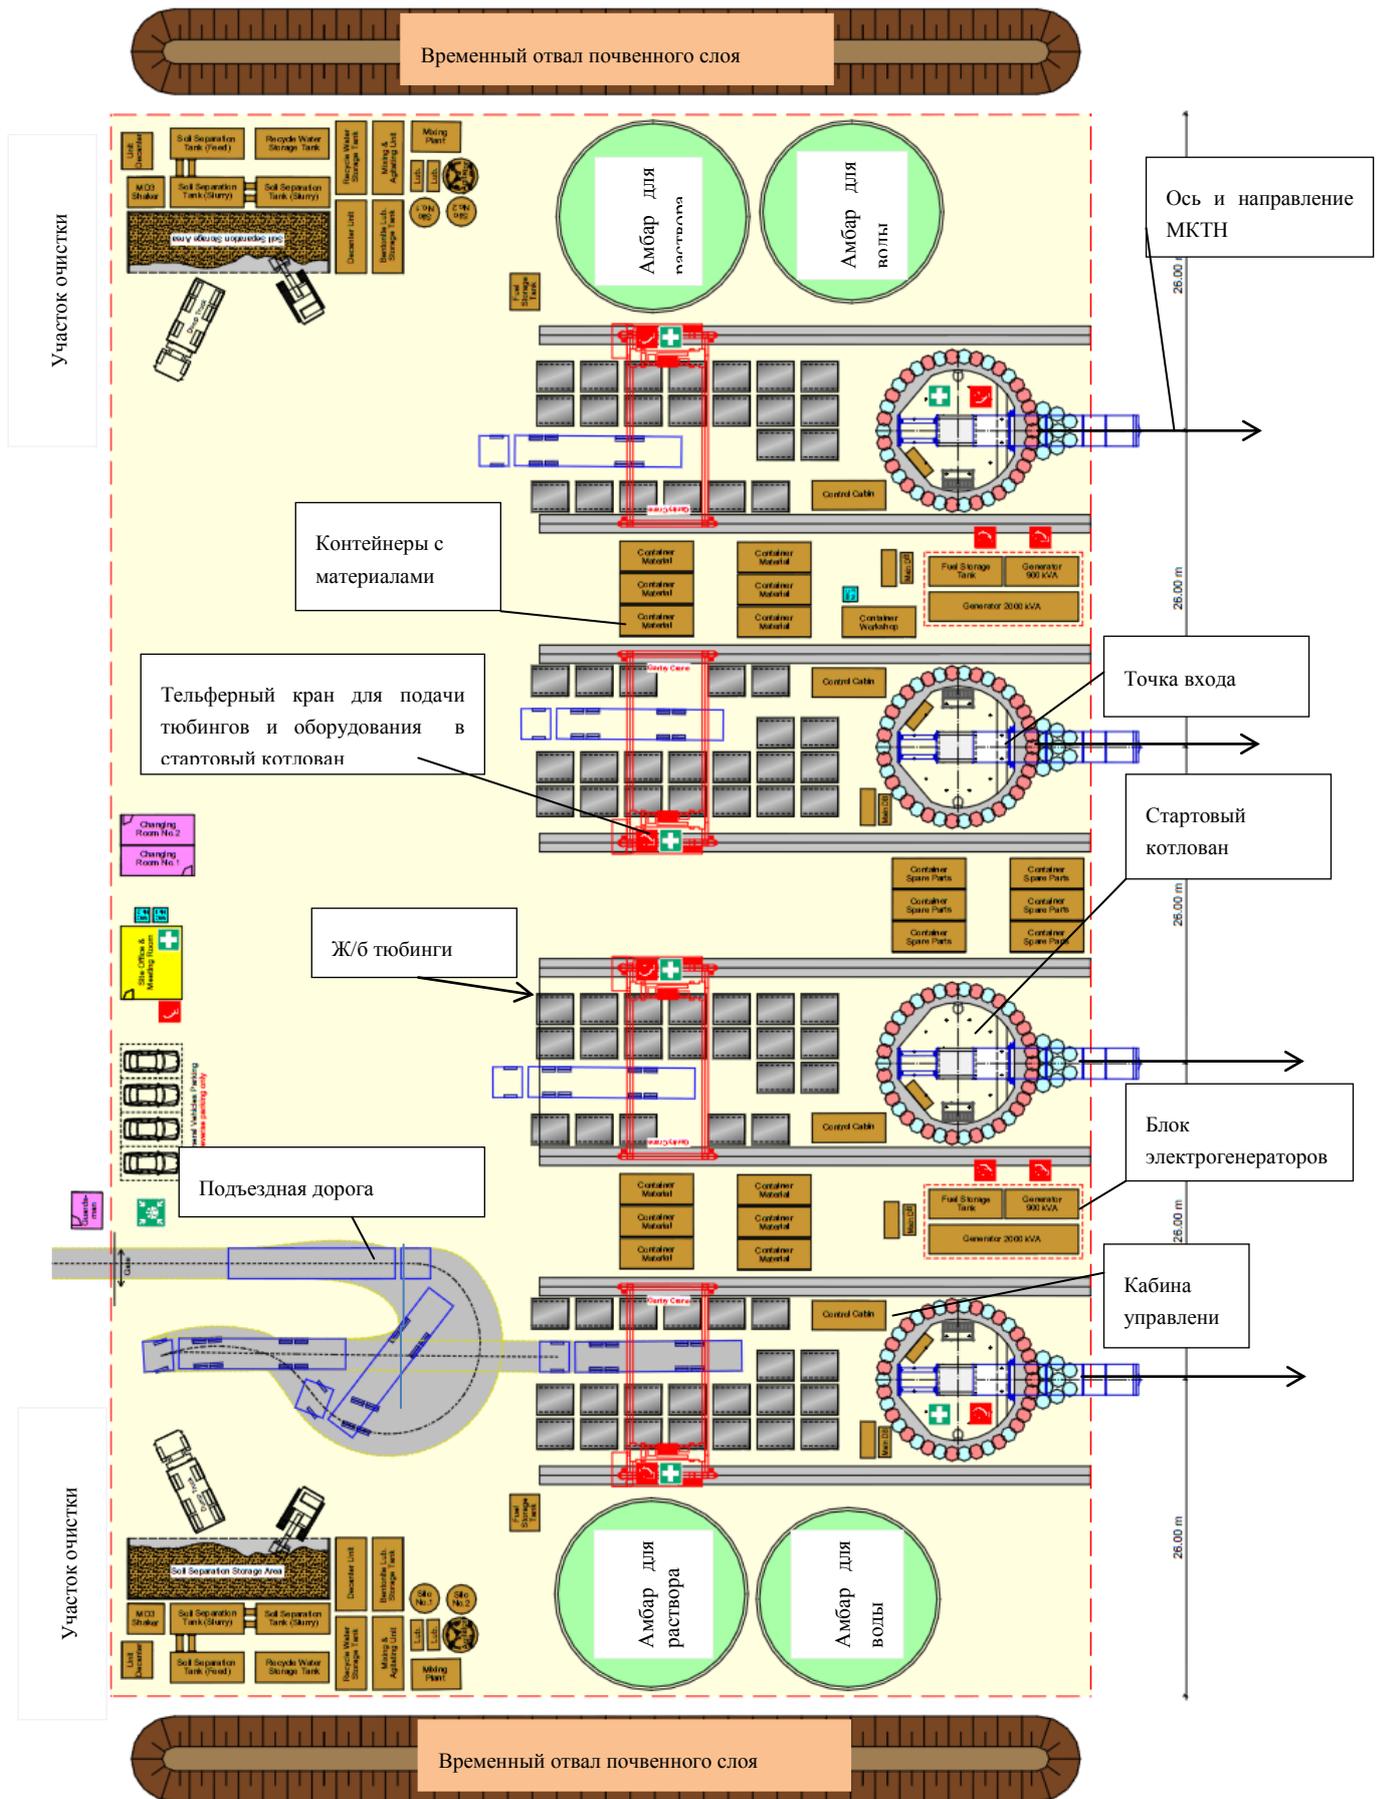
Принципиальная схема обустройства монтажной площадки
